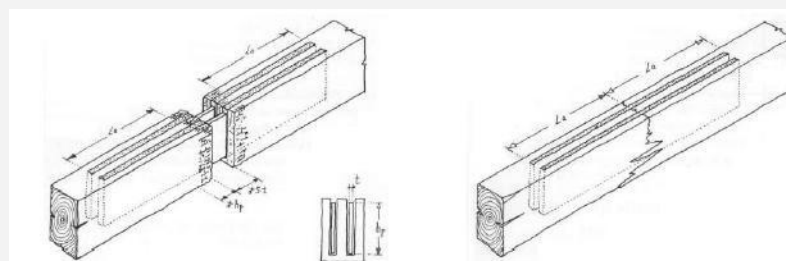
Aplicação de placas de reforço em vigas seladas com cola epoxídica
